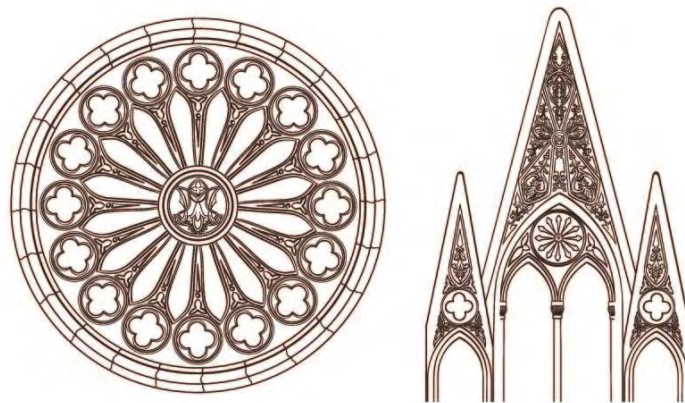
Rosetón y arcos apuntados con tracería calada. [Ilustración]
